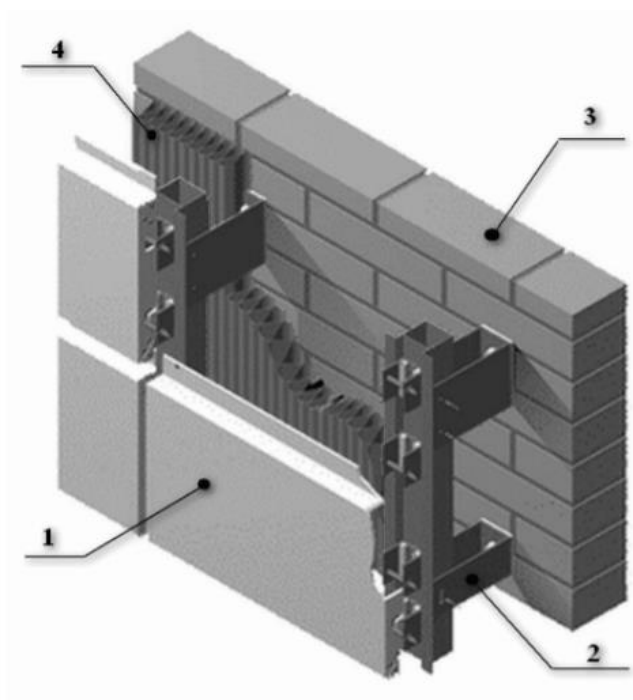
Конструктивна схема навісного вентиляваного фасаду
